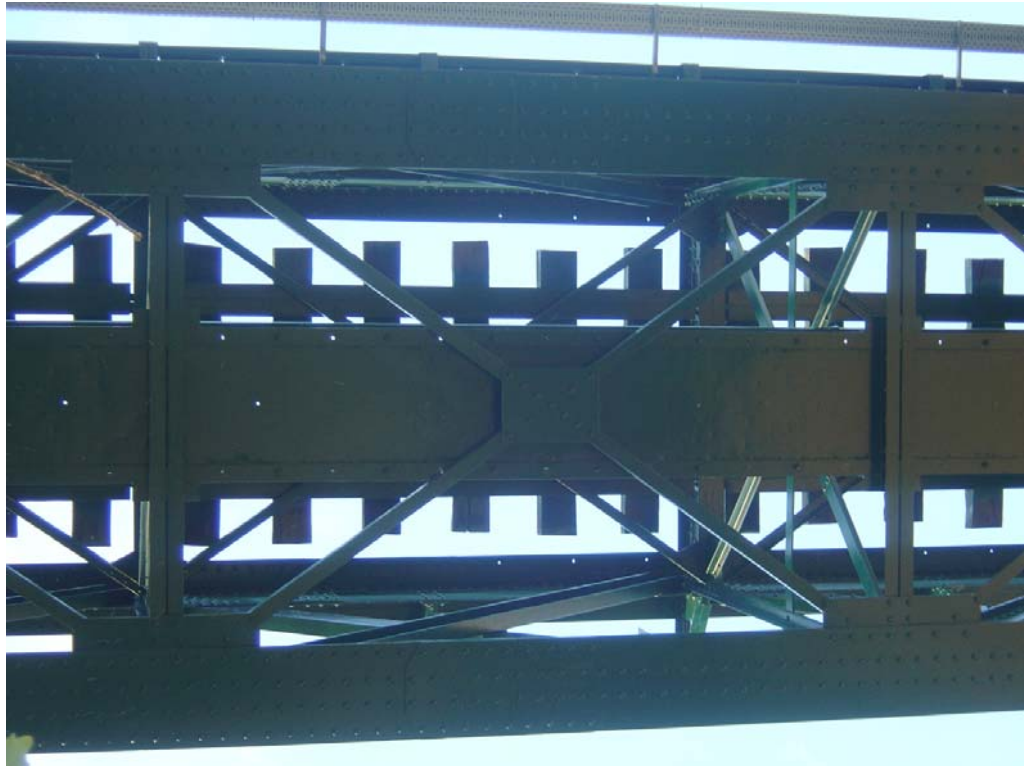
Ponte metálica com 35,0 m de vão – contraventamento inferior (fotografia do autor)
